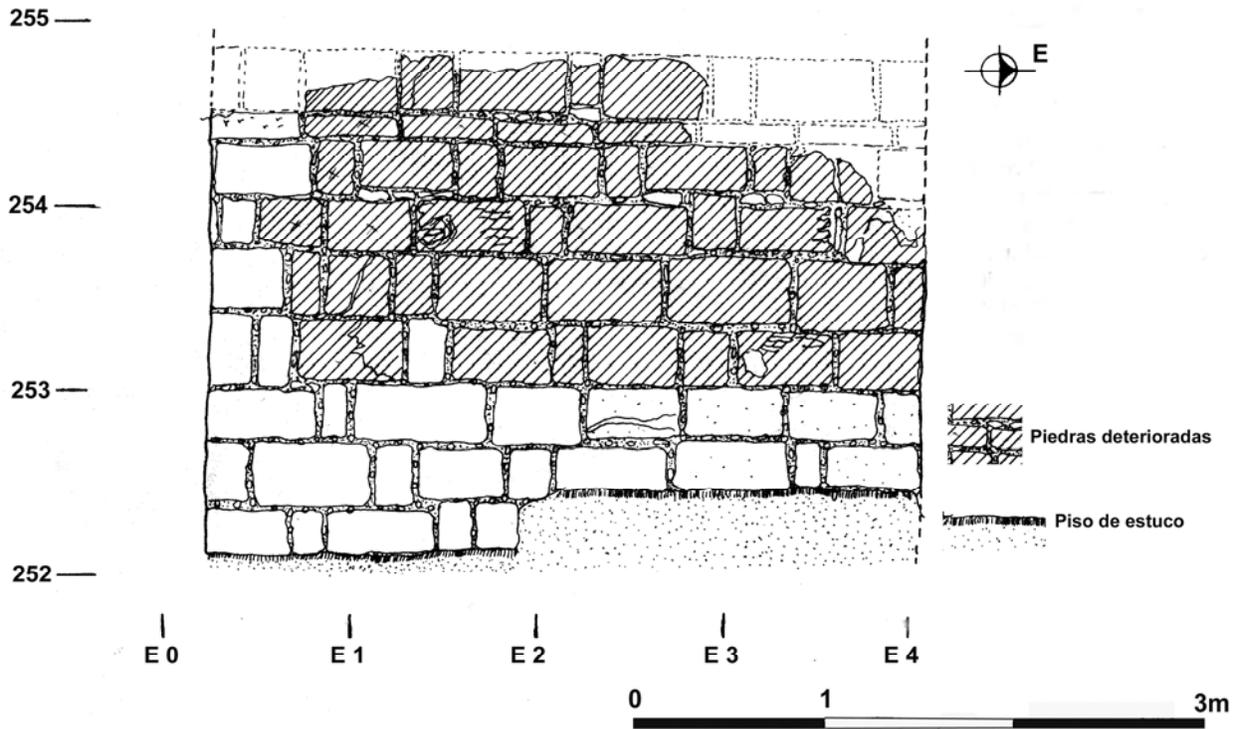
Muro Norte, interior cámara Sur, Estructura 5D-44
